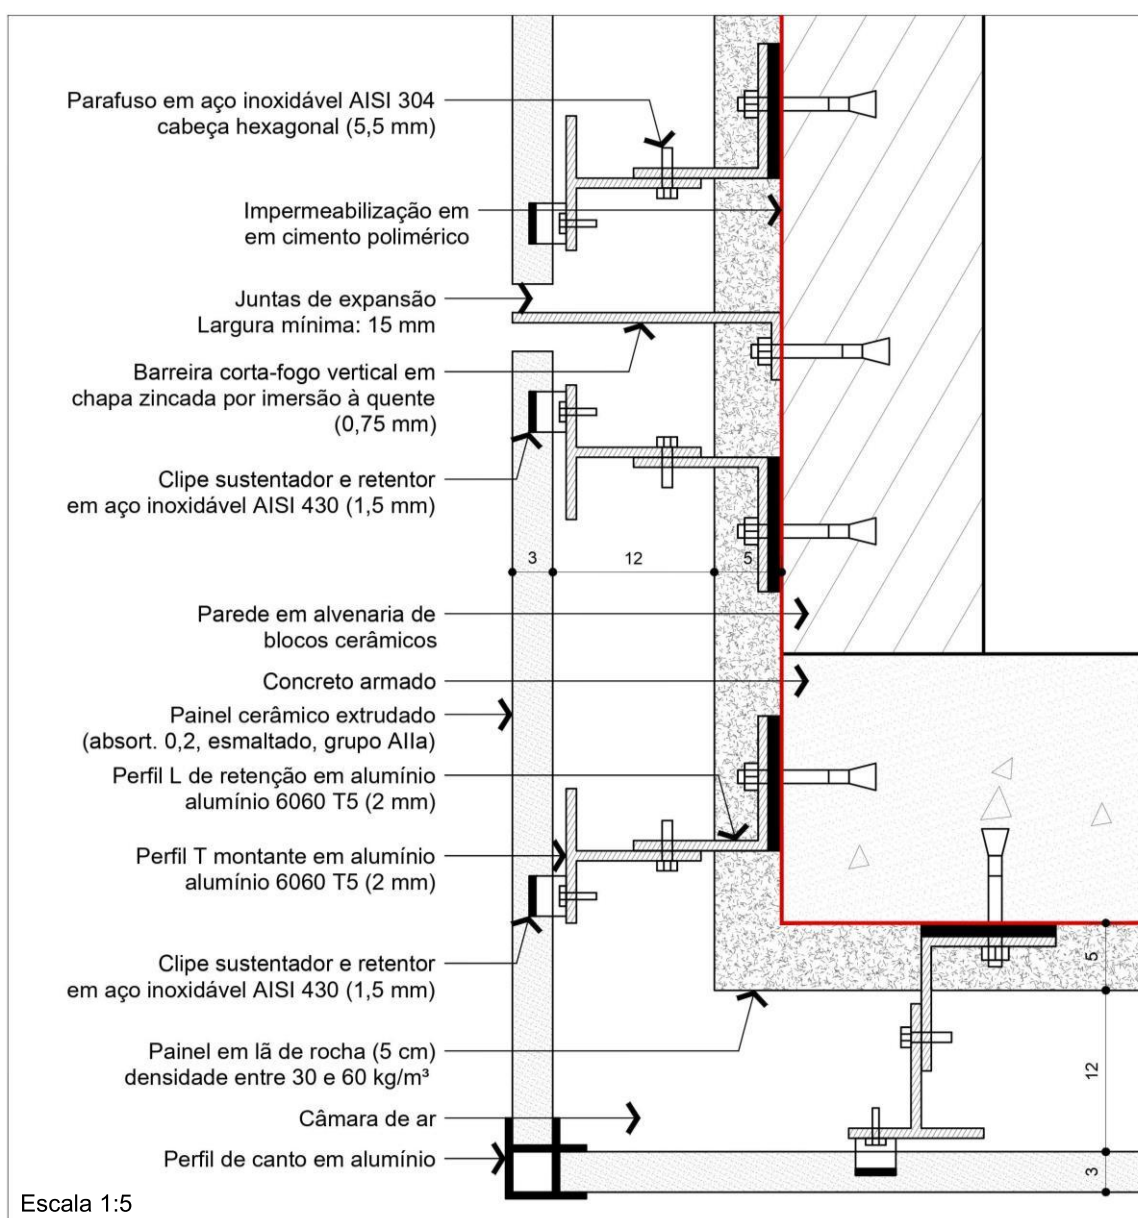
Detalhe construtivo 2 (junta horizontal)
